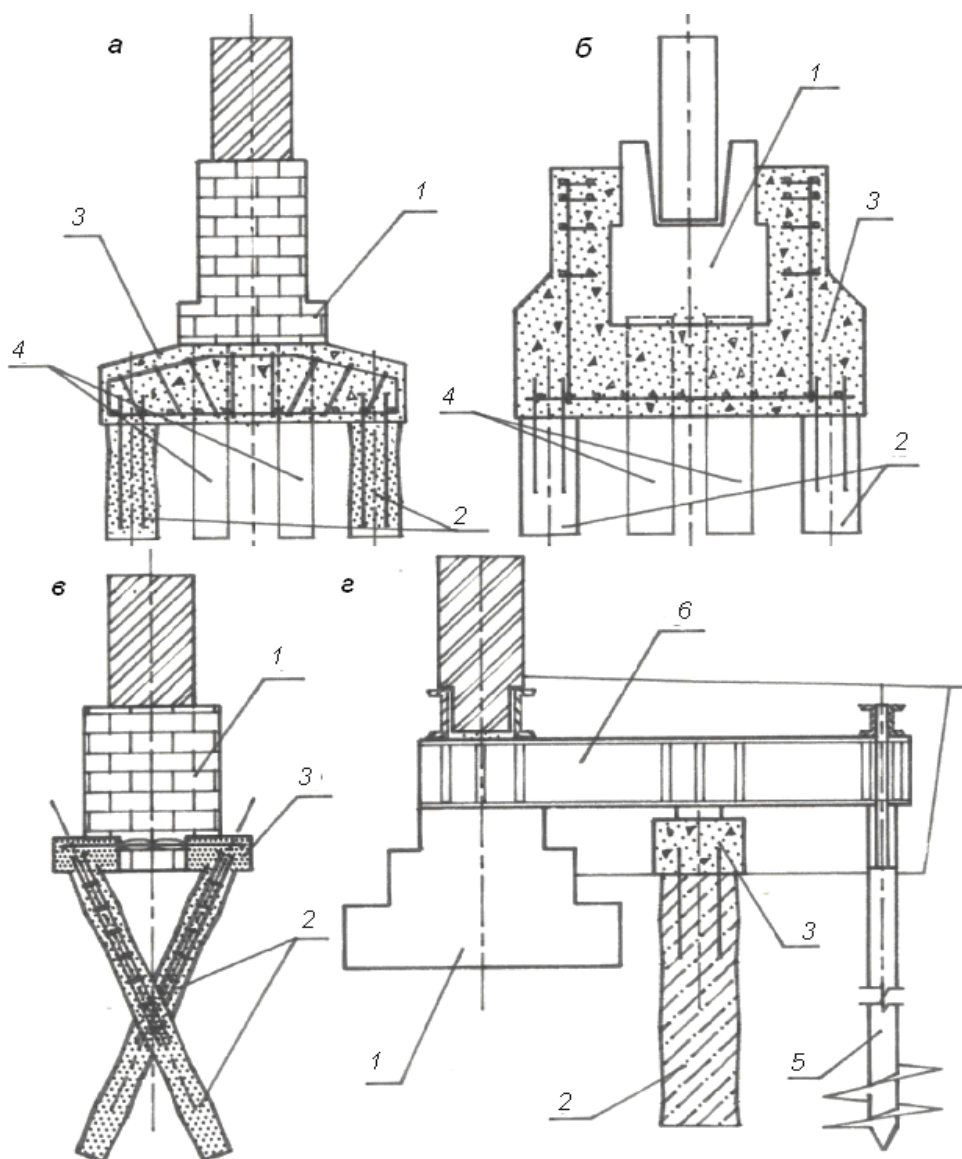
Усиление фундаментов сваями: а – с подводкой нового ростверка под ленточный фундамент; б – то же под столбчатый фундамент; в – наклонными сваями; г – сваями с одной стороны: 1 – существующий фундамент, 2 – сваи усиления, 3 – монолитный ростверк, 4 – существующие сваи, 5 – свая с винтовым наконечником, стальная балка
